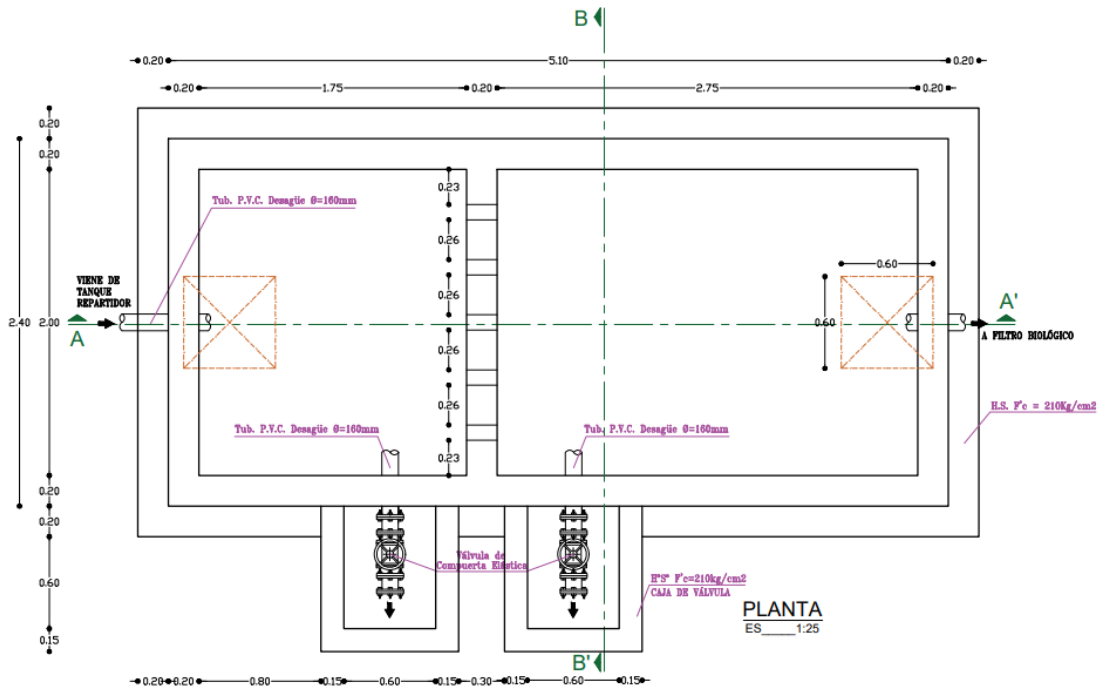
Vista en Planta del Tanque Séptico 1 y 2 de la PTAR.
